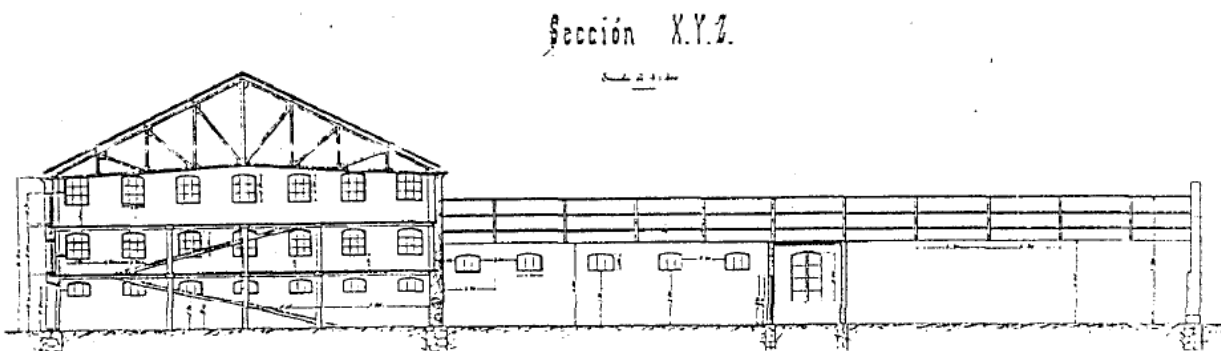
Sección transversal por la nave grande, y longitudinal por la nave de una planta.
